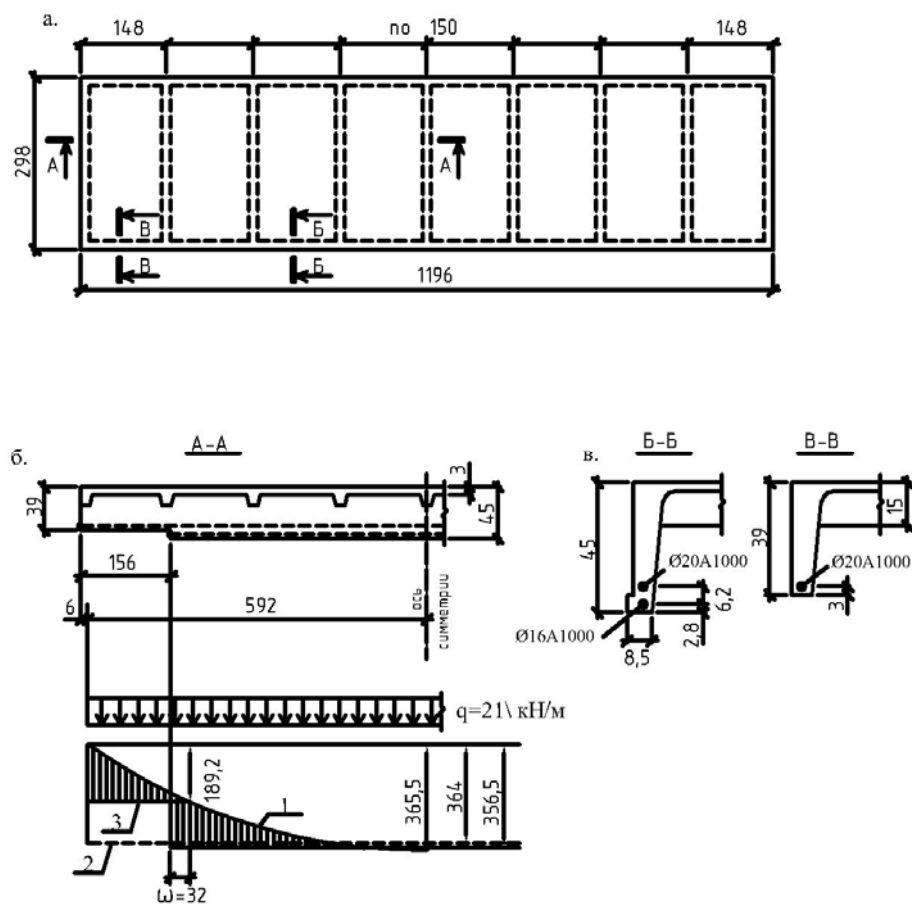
Железобетонная плита с ребром ступенчатого очертания в растянутой зоне (вид1).
